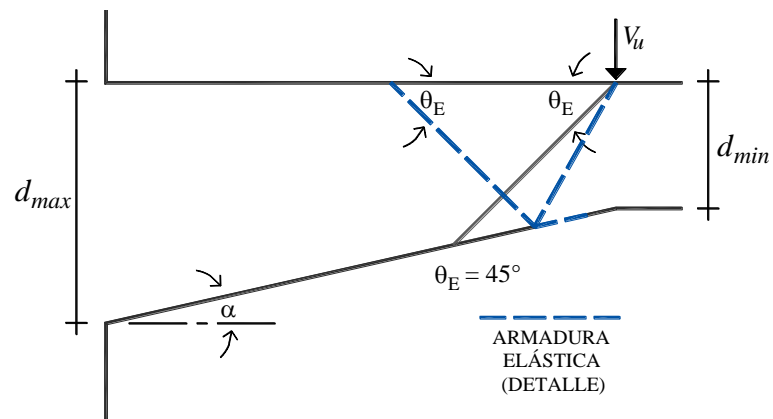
Modelo de armadura sugerido para cuantificar la contribución del concreto en las traves acarteladas sin refuerzo transversal (carga gravitacional)
